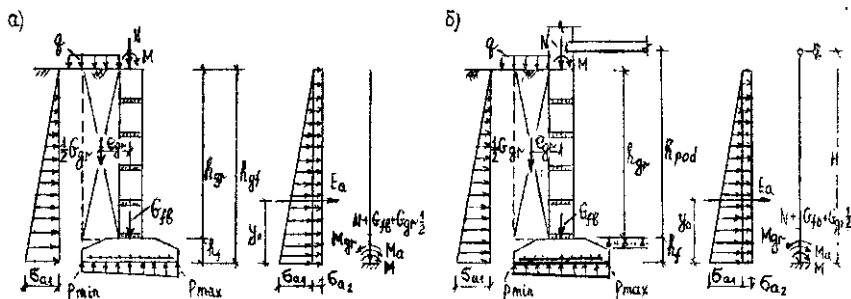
Расчётные схемы внецентренно нагруженного ленточного фундамента при производстве обратной засыпки грунта: а — до устройства пола подвала и надподвального перекрытия, б — после устройства пола подвала и надподвального перекрытия
